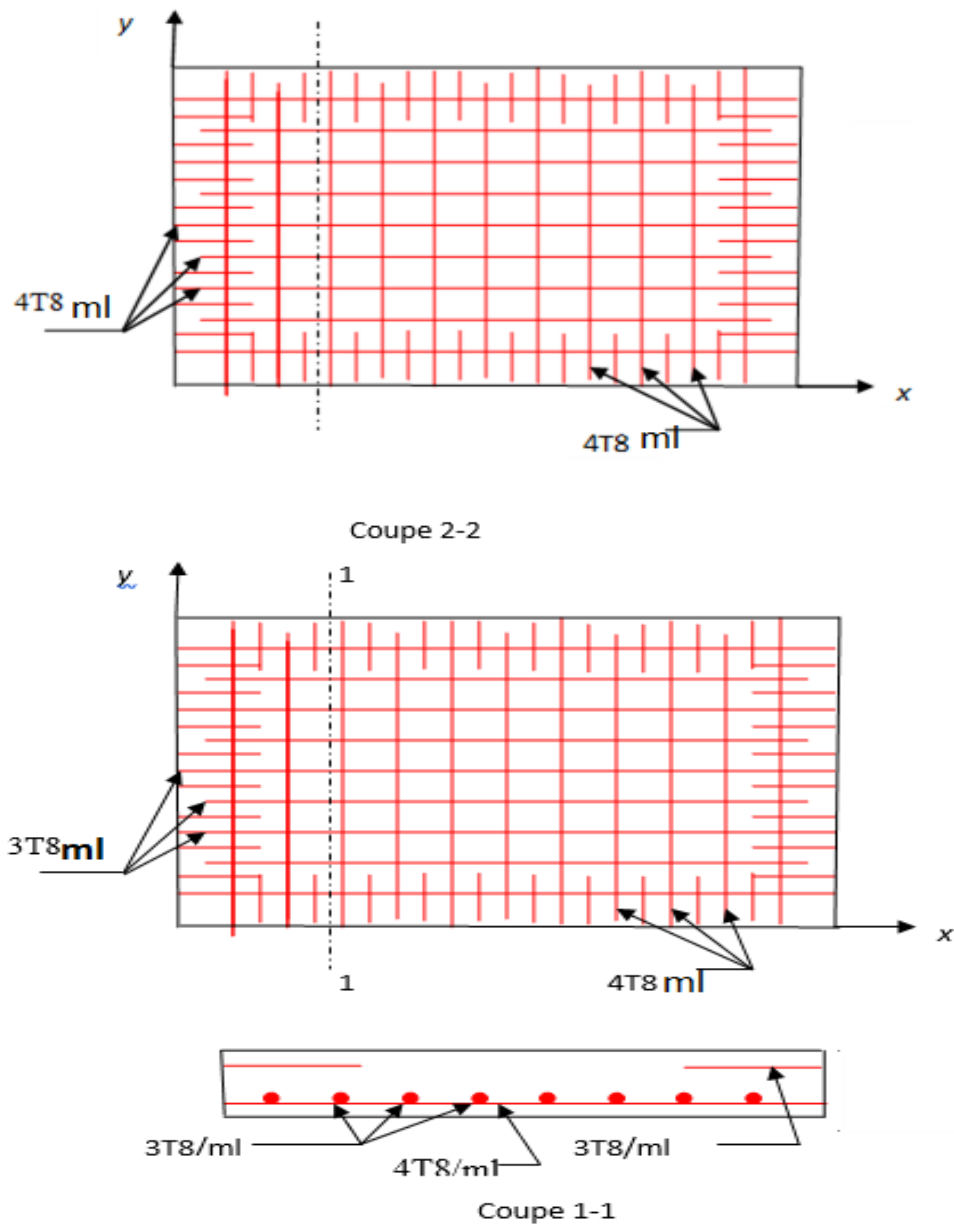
Schéma de ferrailage de la dalle d'ascenseur
